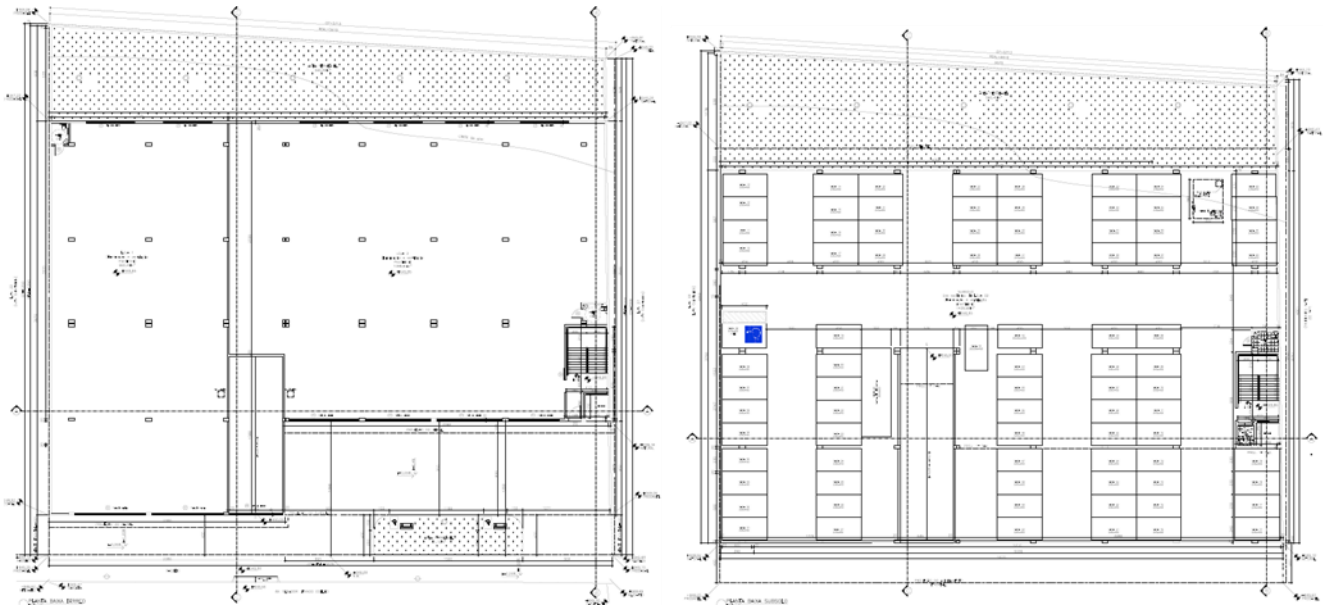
Planta baixa das edificações: Subsolo e 1º andar
